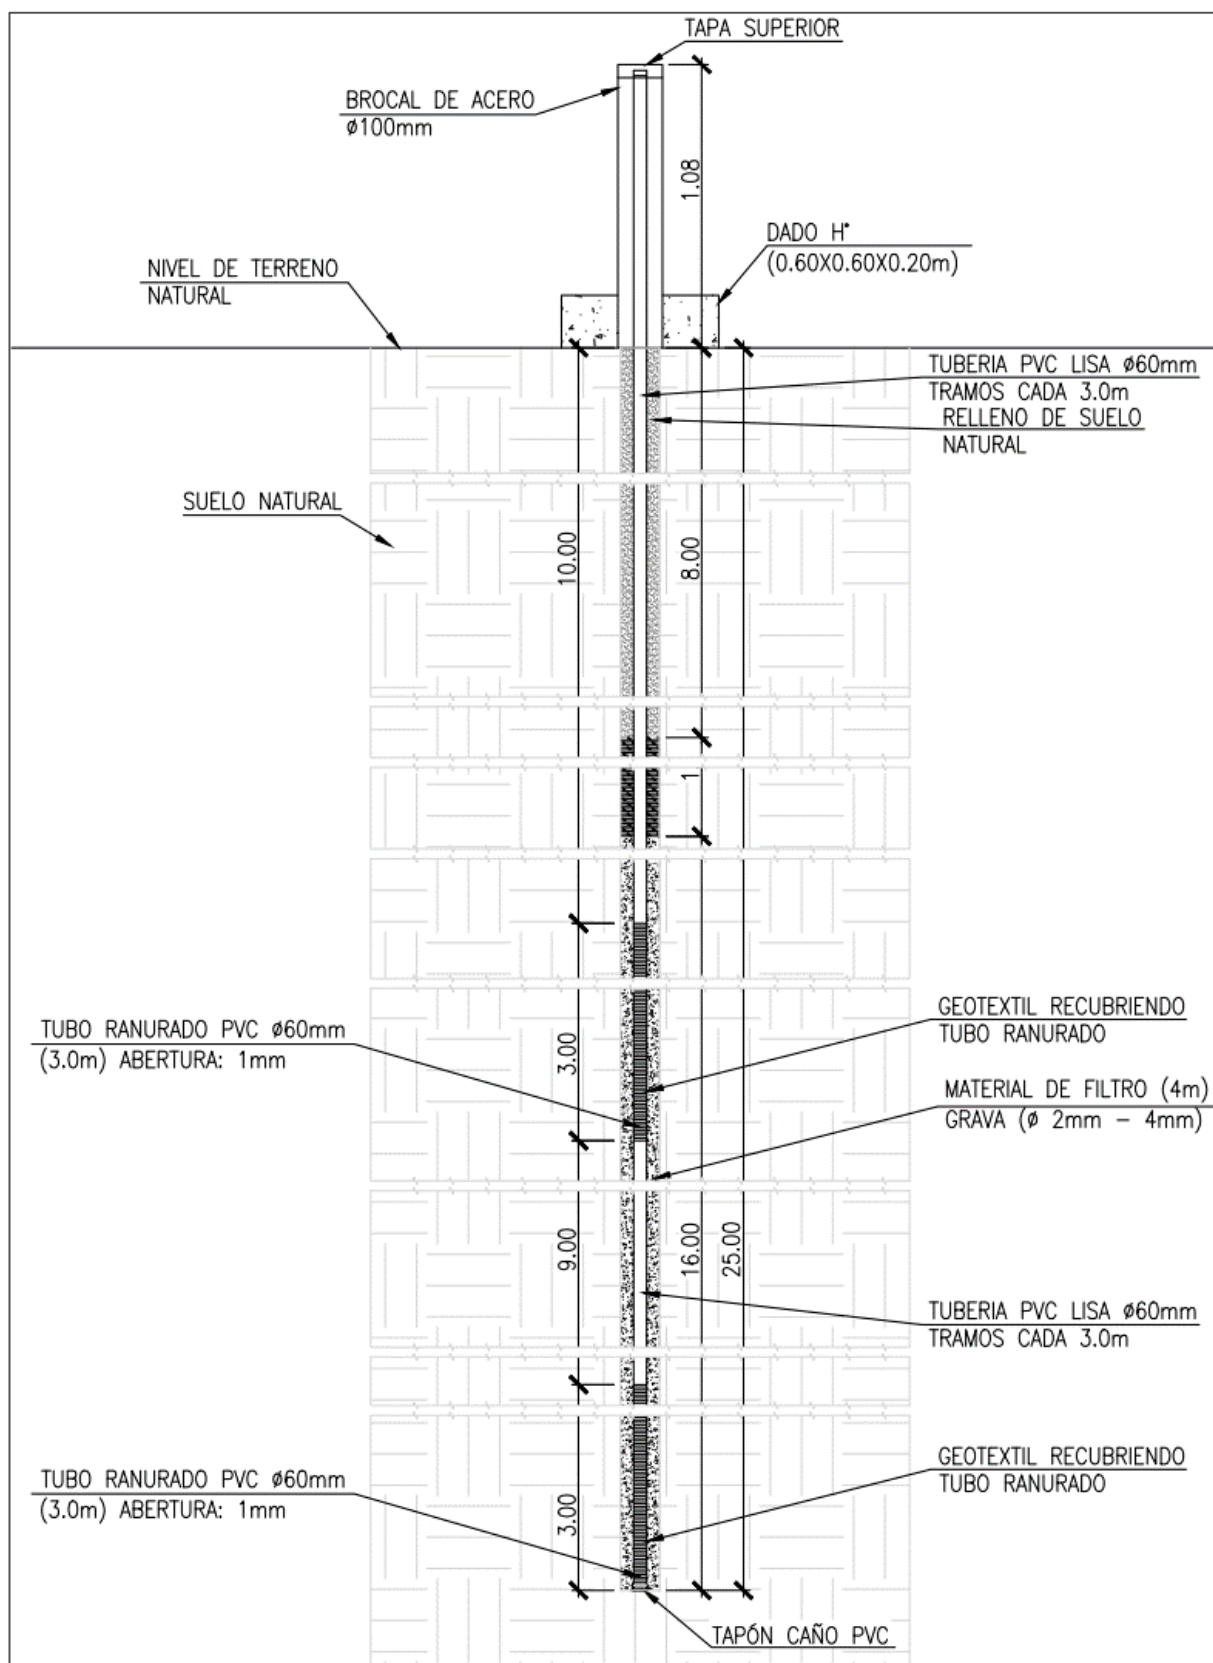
Esquema en detalle del perfil SRK-2023-BH03
